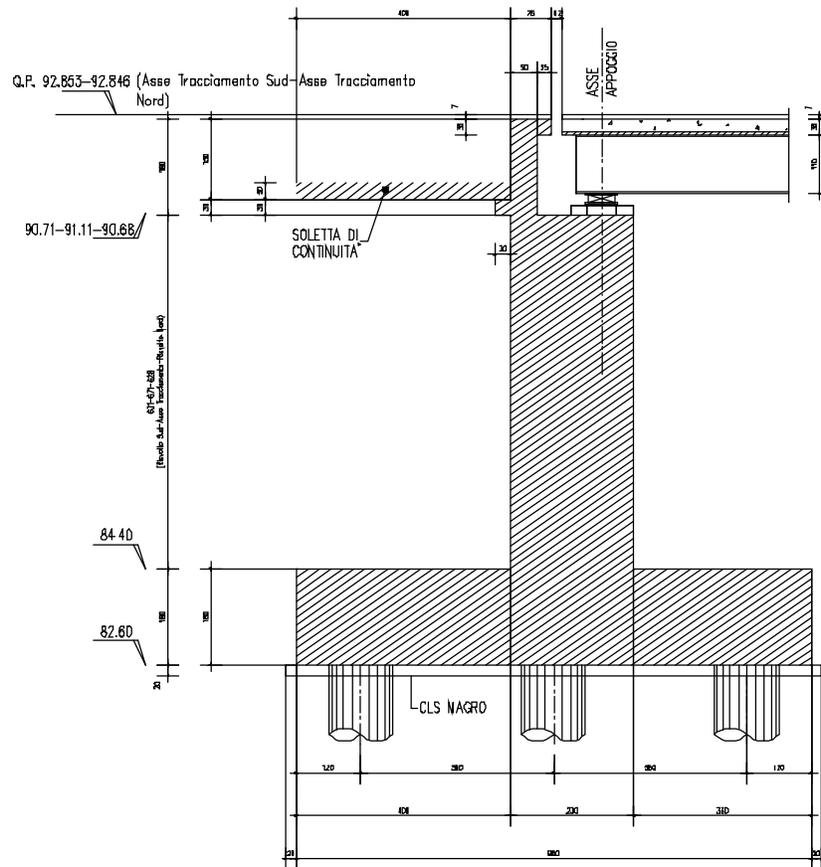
Sezione trasversale spalla in retto alla direzione spalla
